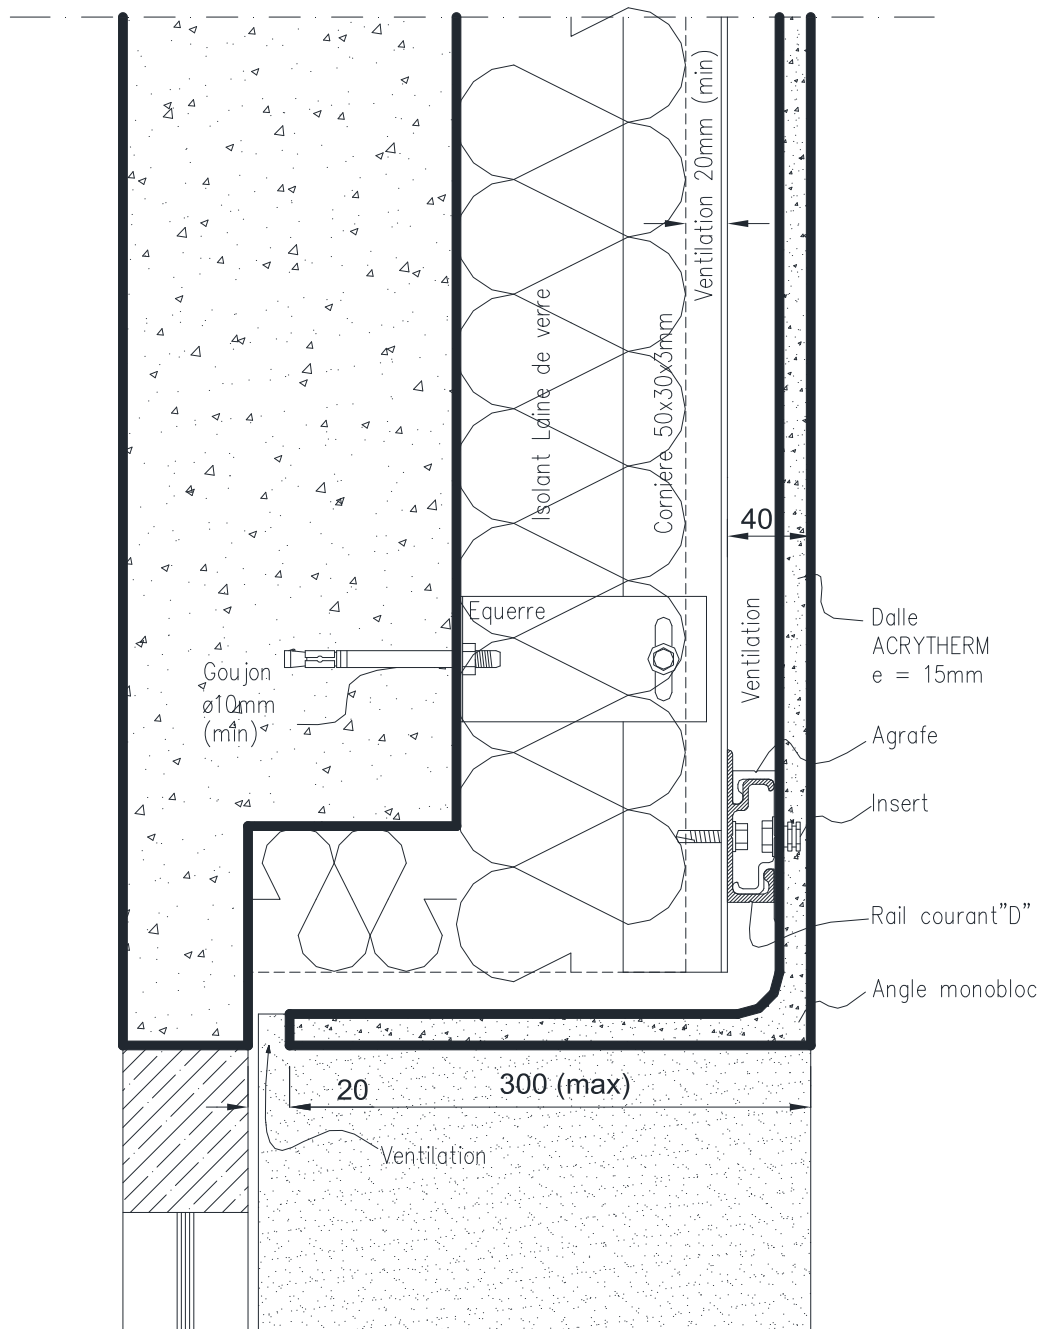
er – Coupe verticale sur linteau – Dalle monobloc
